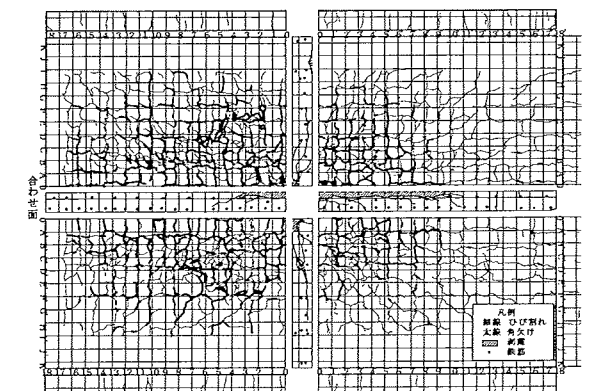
No. 20 供試体下面のひび割れ
